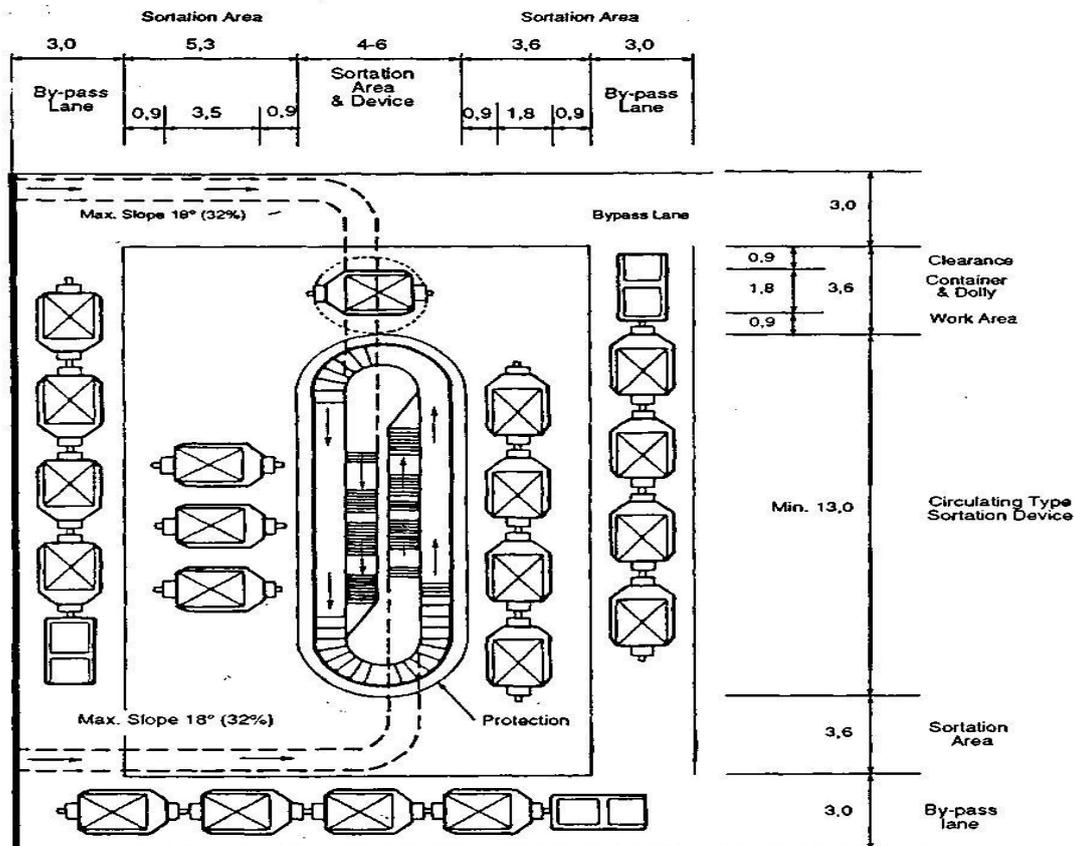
Система сортировки убывающего багажа с несколькими источниками его подачи (Dimensions in meters)
